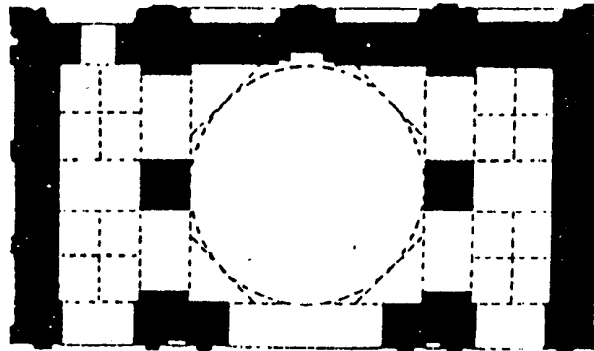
مسقط أفقي لمسجد زاوية (مدرسة) عموره بجنزور في ليبيا
